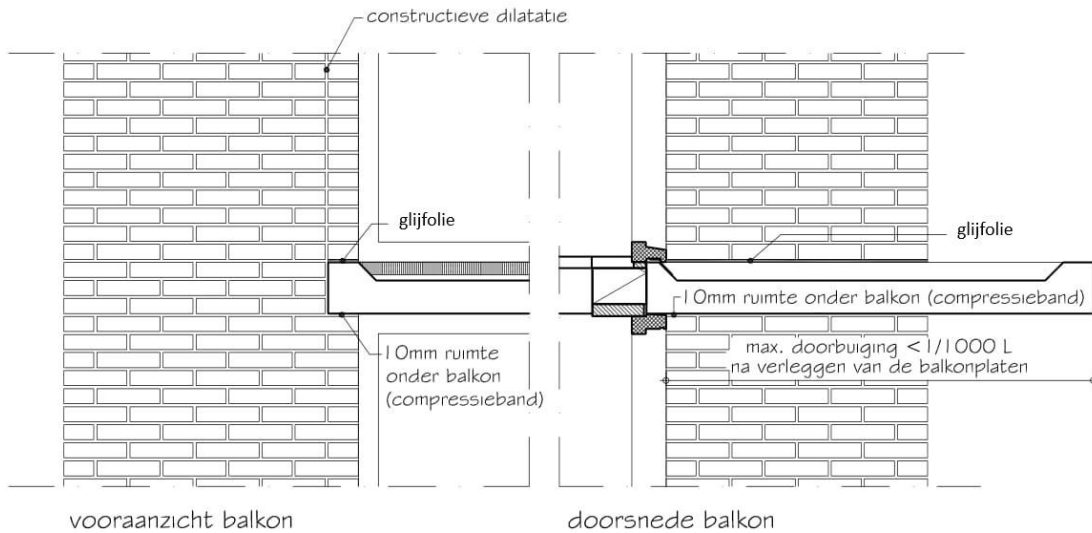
Aansluiting prefab betonnen galerij-/balkonvloer
